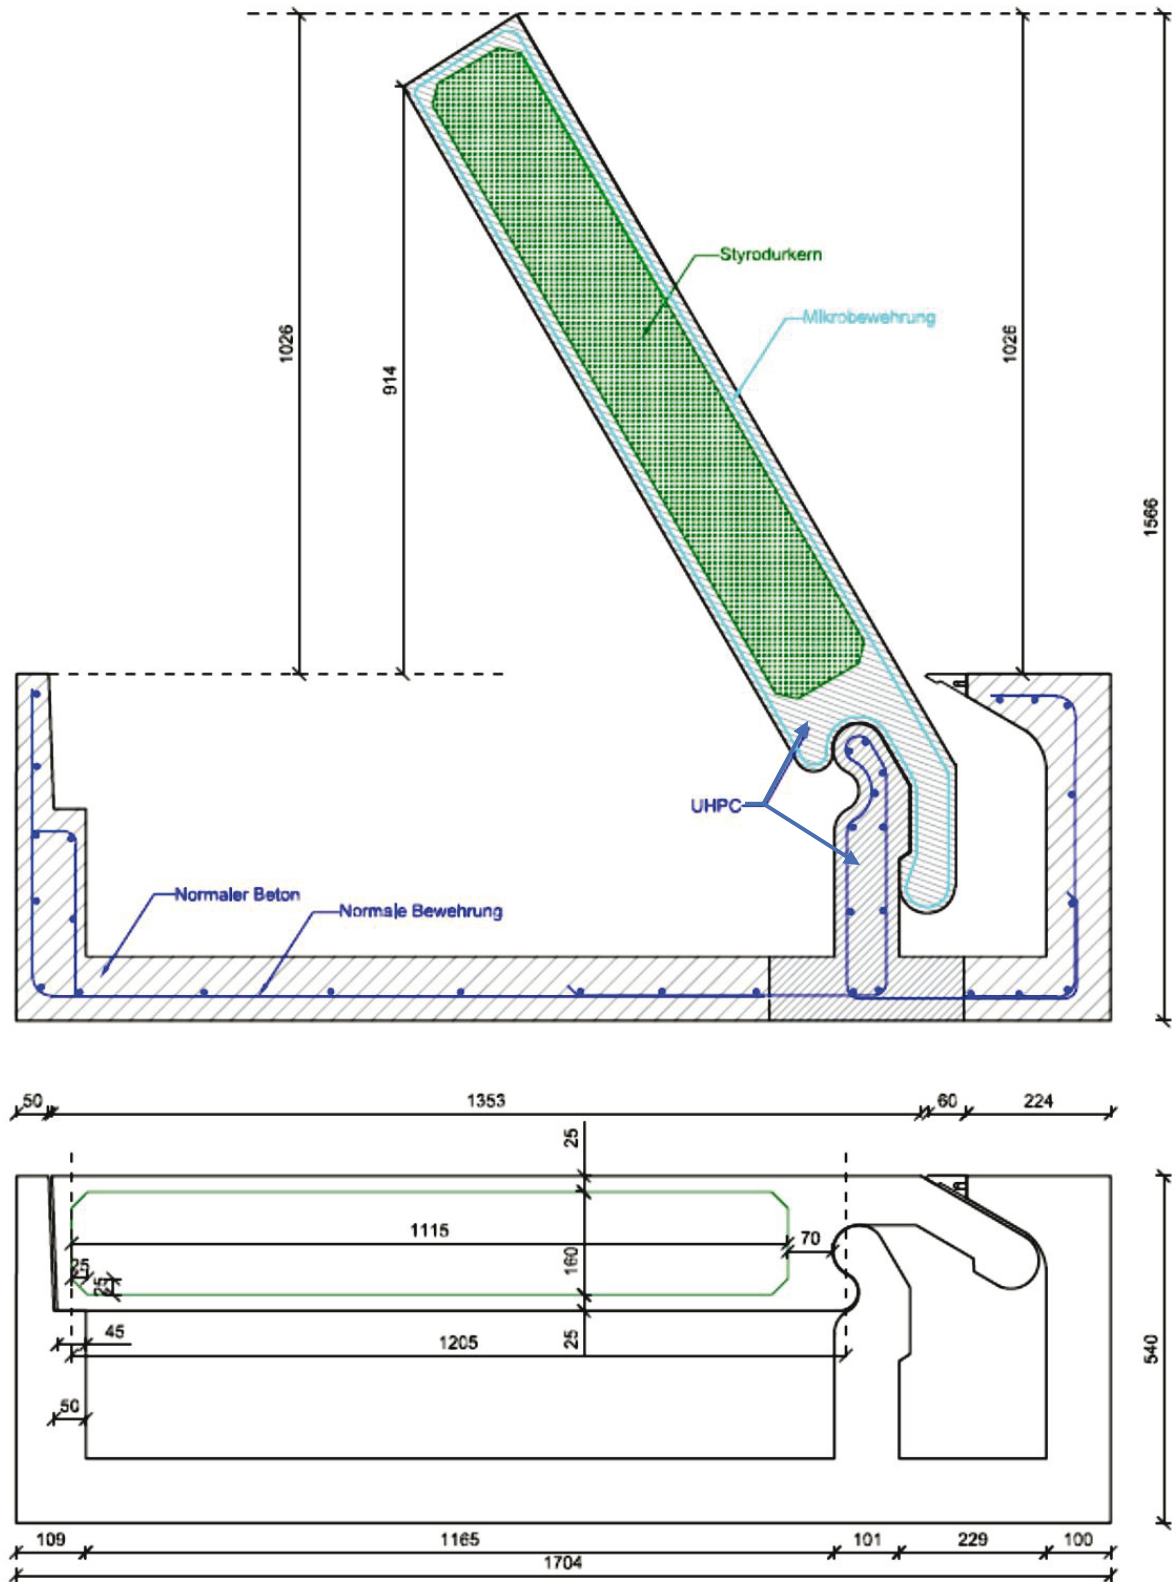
Abmessungen die Bewehrung, Kennzeichnung von UHPC und Normalbeton Baustoffe
